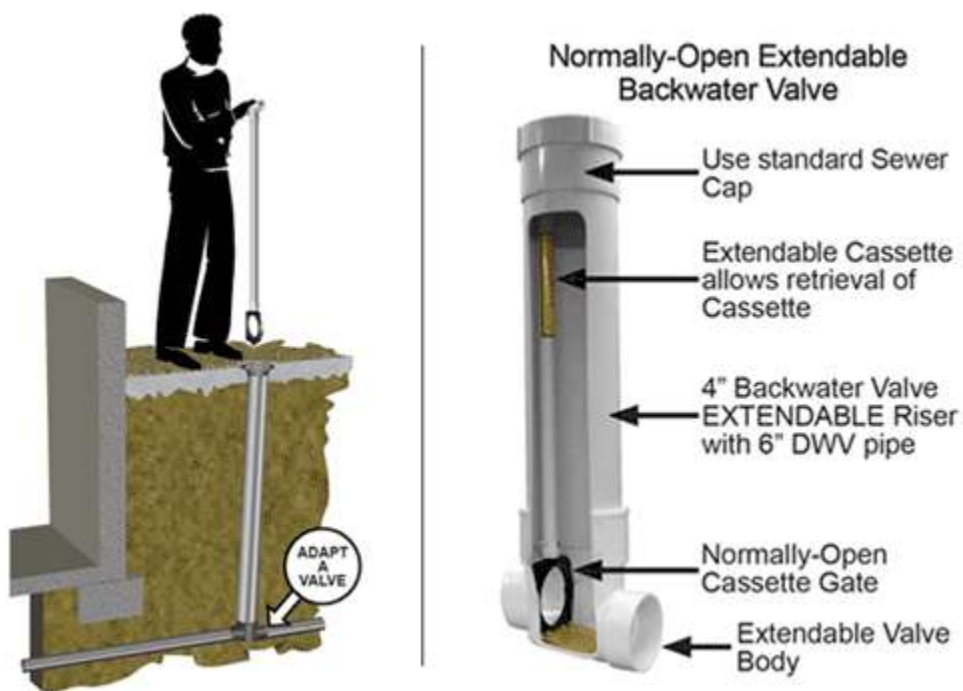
Exemple de clapet anti-retour pouvant s'installer à l'extérieur, à moins d'un mètre du mur de fondation
